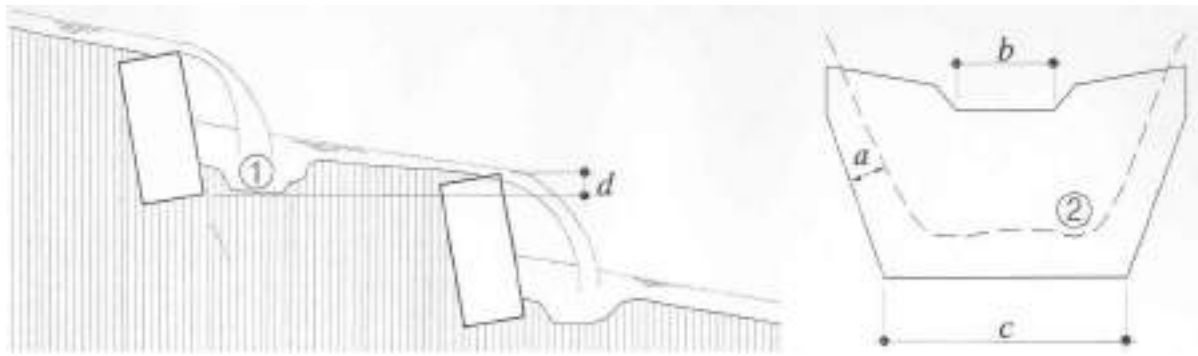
Abmessungen des Querwerks: Ansicht und Längsschnitt
